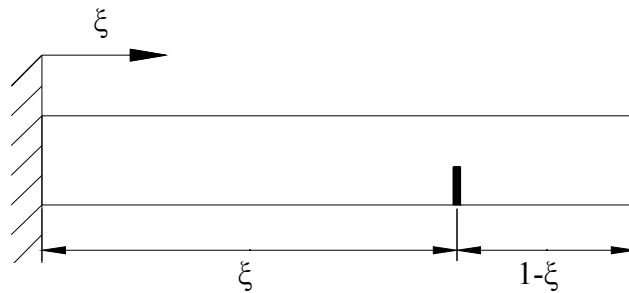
Elemento de viga trincado em coordenadas locais
